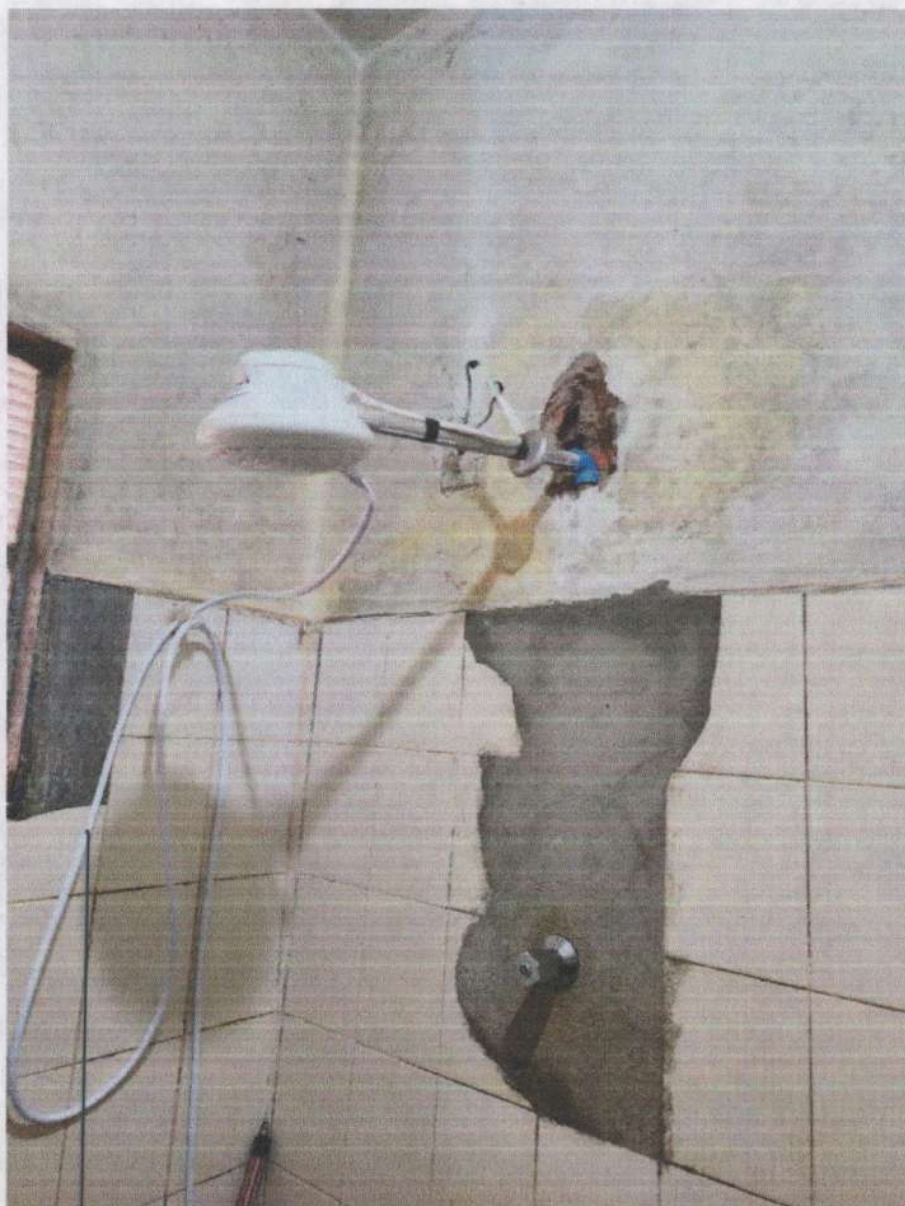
Banheiro com instalações antigas, patologias de infiltração, fiações expostas e parede deteriorada no chuveiro.
